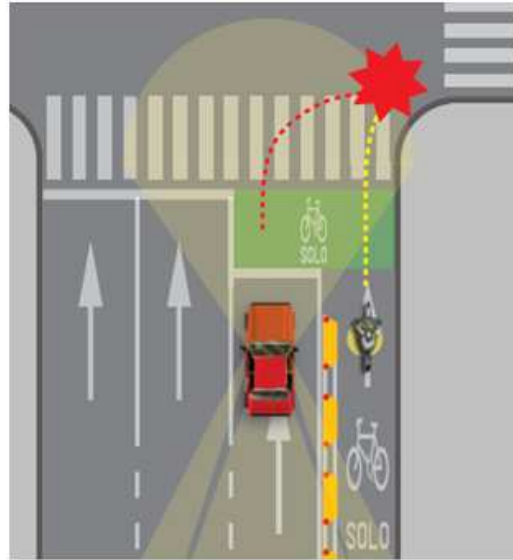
Imagen 65 carriles laterales de la ciclovía separado con los automóviles.
